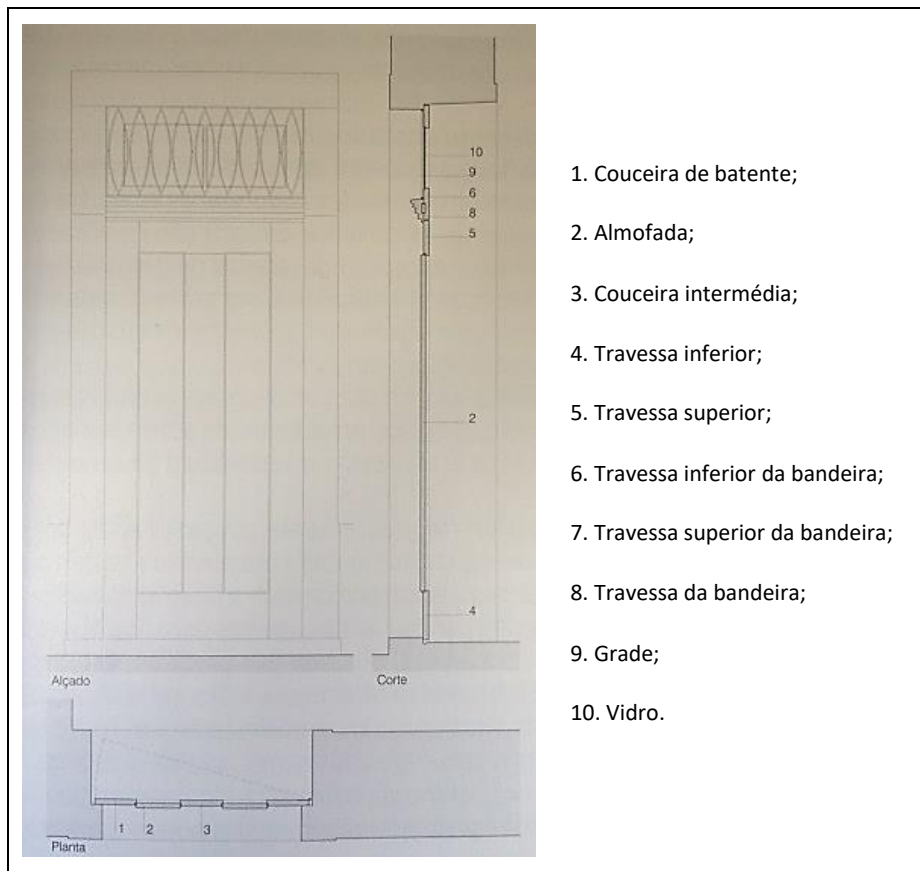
Alçado corte e planta de uma porta exterior [1]
